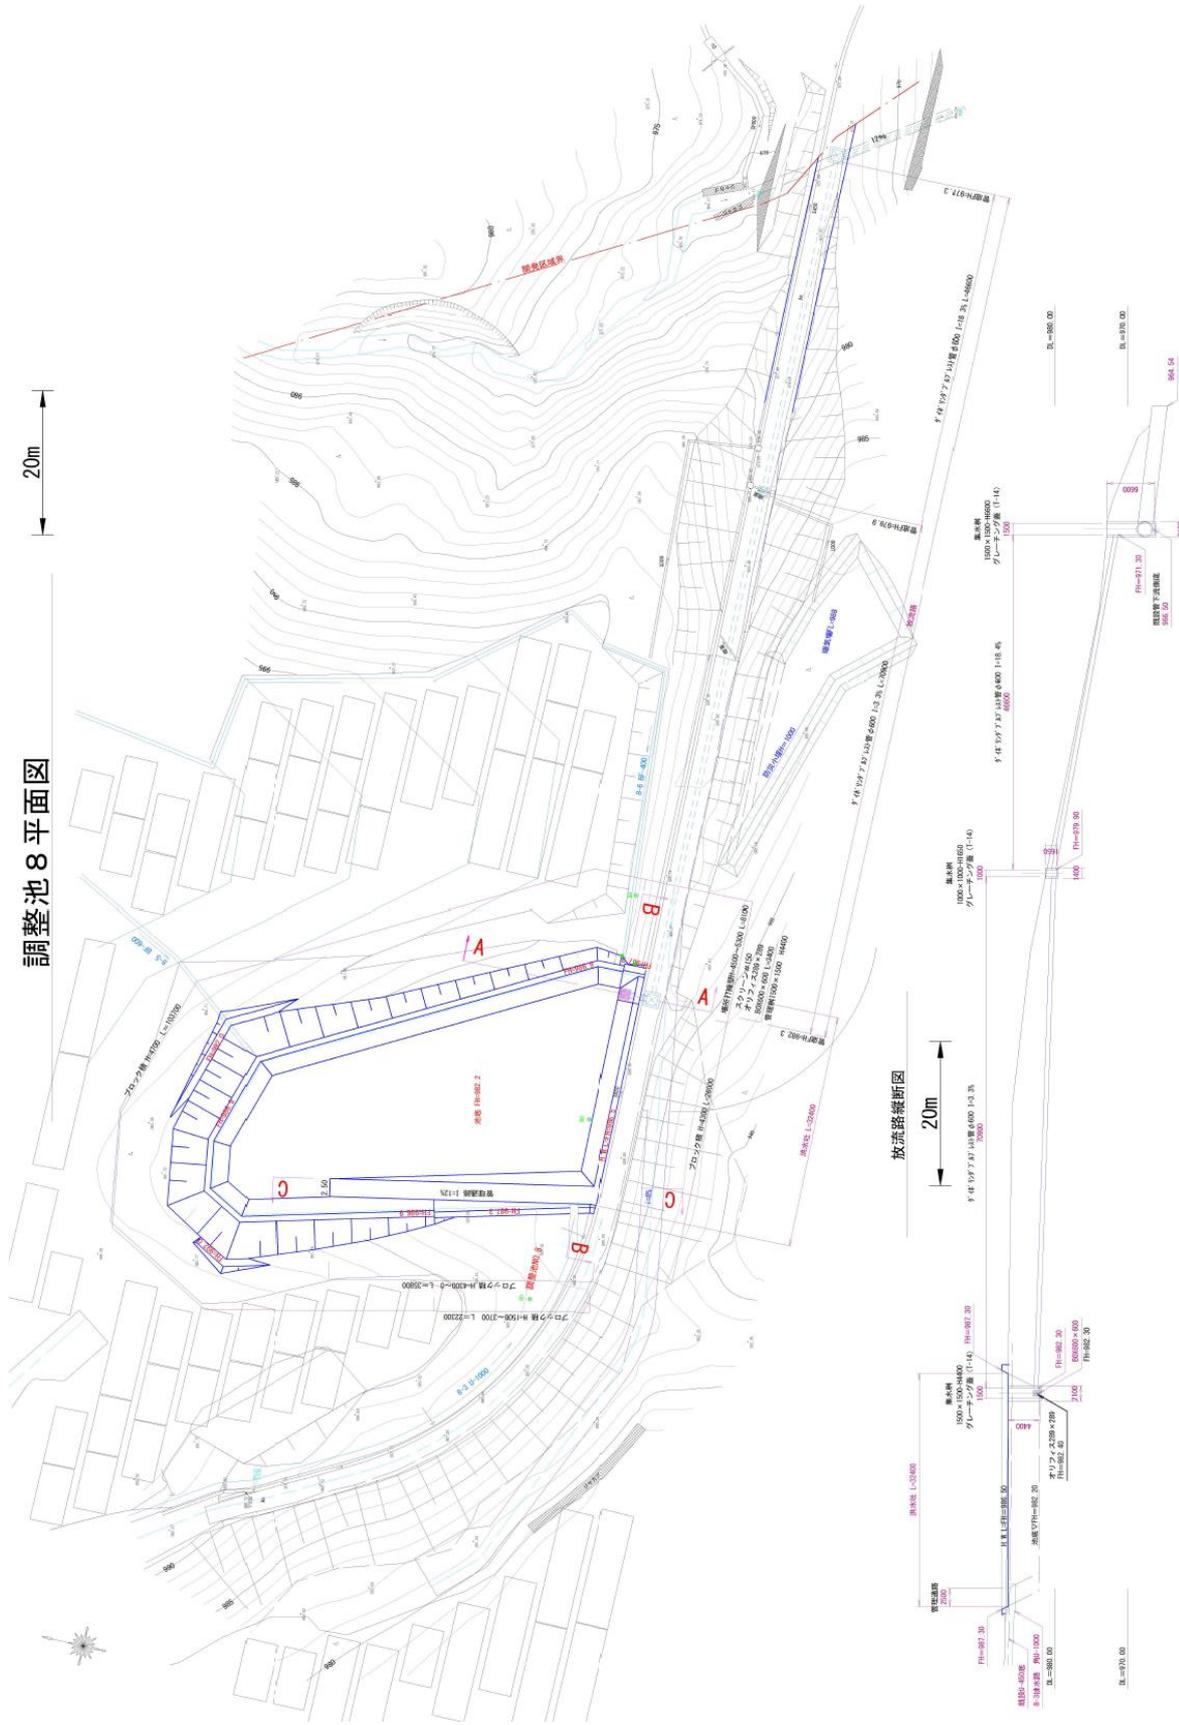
(12) No.8 調整池計画図 (平面図・断面図)
